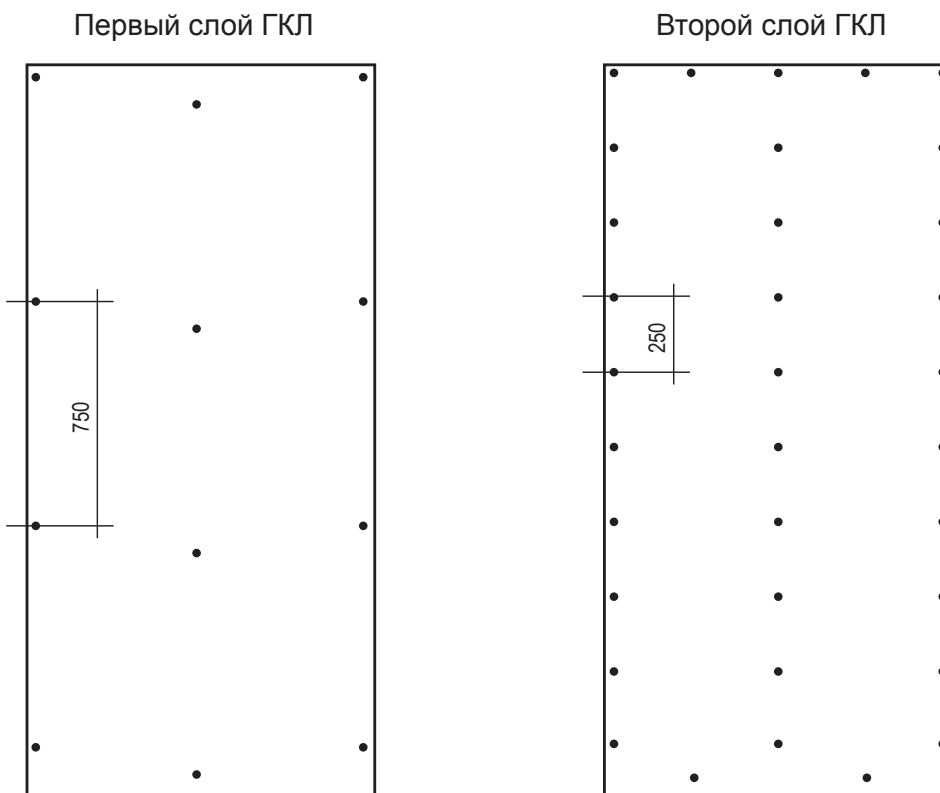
Схема расположения шурупов при двухслойной облицовке ГКЛ
